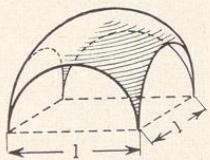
Stutzkuppel über quadratischem Grundriss
